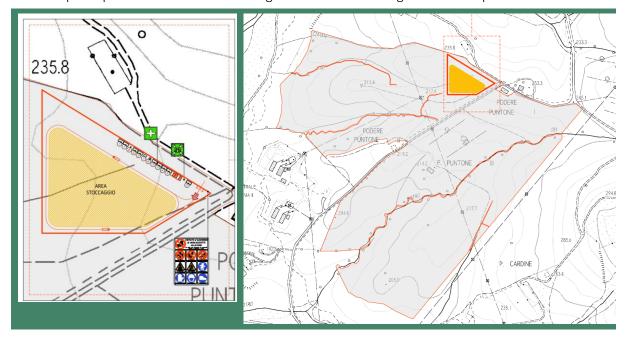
Stralcio delle aree di stoccaggio di cantiere.
